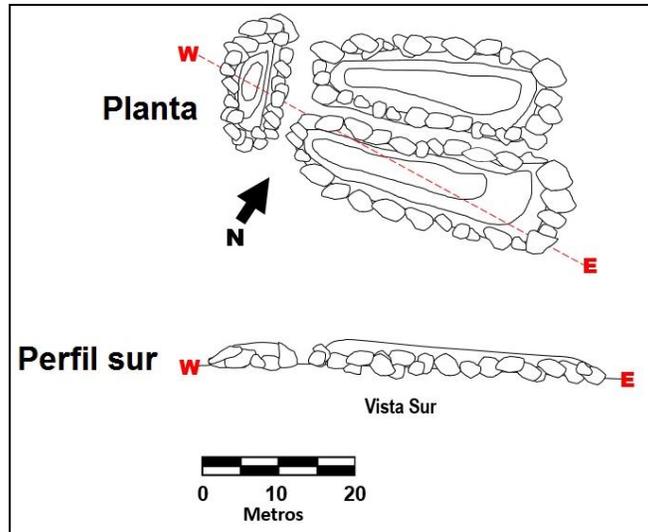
Planta y perfil del elemento arquitectónico 7, cancha con cabezal (dibujo de la autora).
